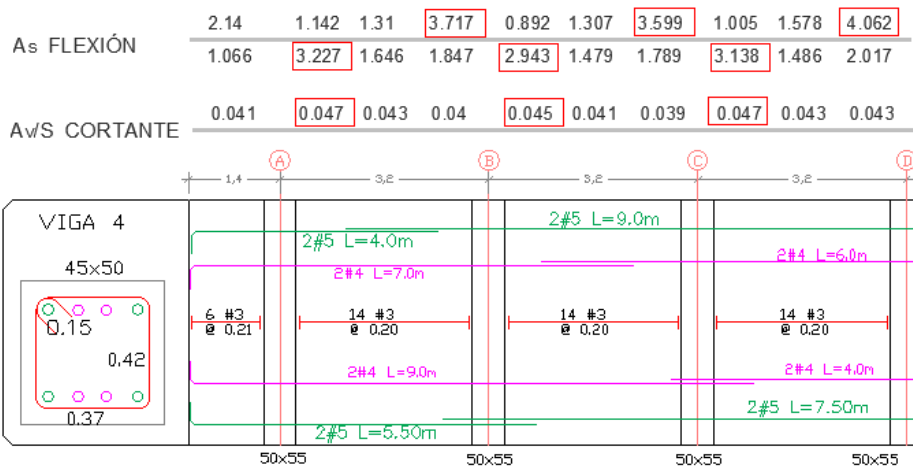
Cuantías obtenidas por esfuerzo a flexión, cortante y despiece de la viga 4 de la planta estructural. Fuente: elaboración propia.
